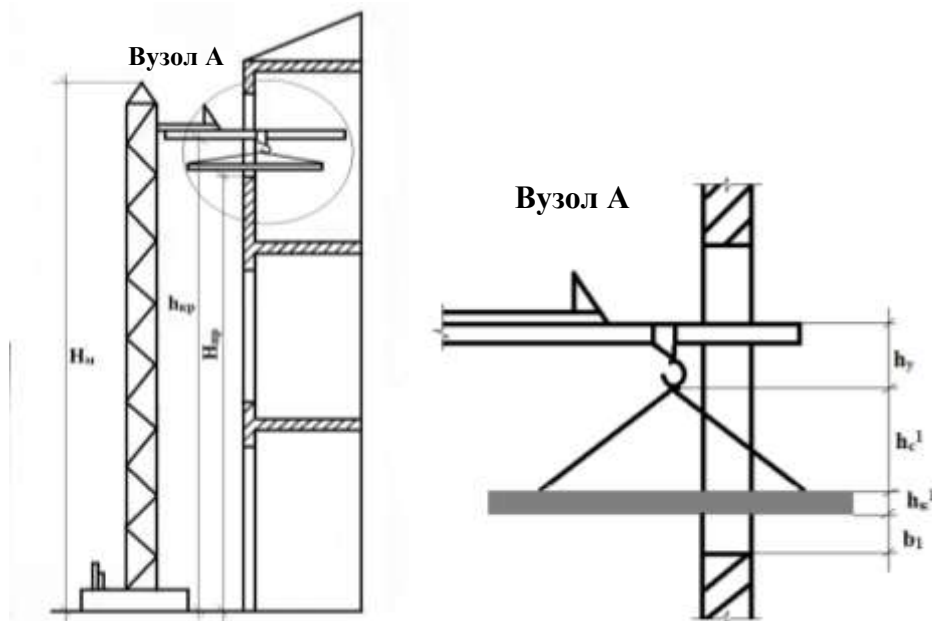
Монтаж конструкцій через отвори будівлі
